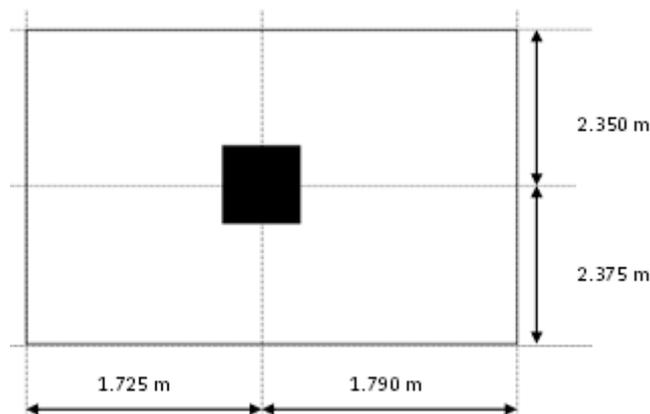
Surface supportant la charge revenant au poteau le plus sollicité.
